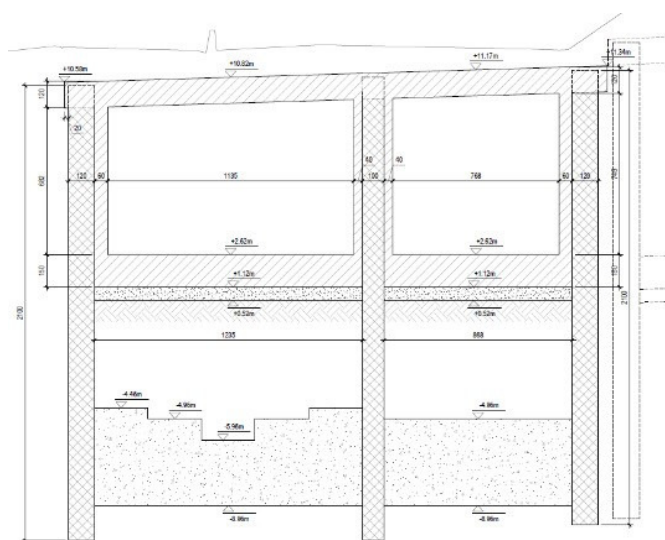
Galleria artificiale Fornaci II – Planimetria di progetto
